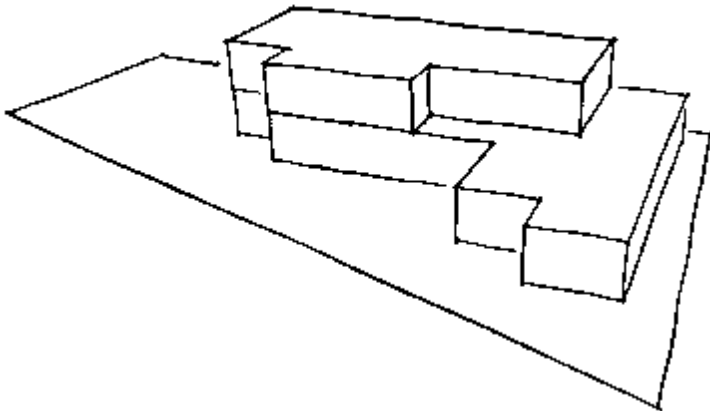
Volumetría basada en la planta arquitectónica. C. E. Gómez G.
